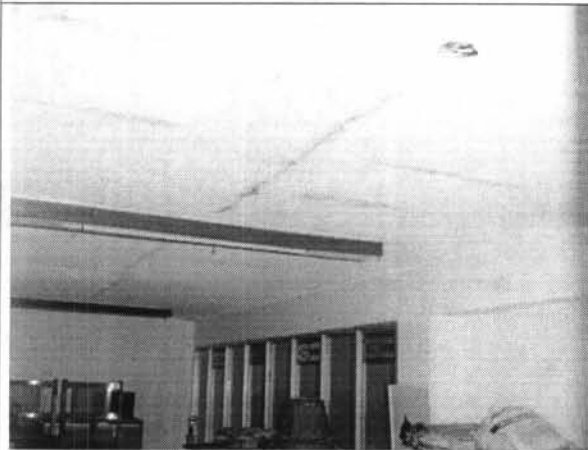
Fisuras en la cubierta del mezanine.
